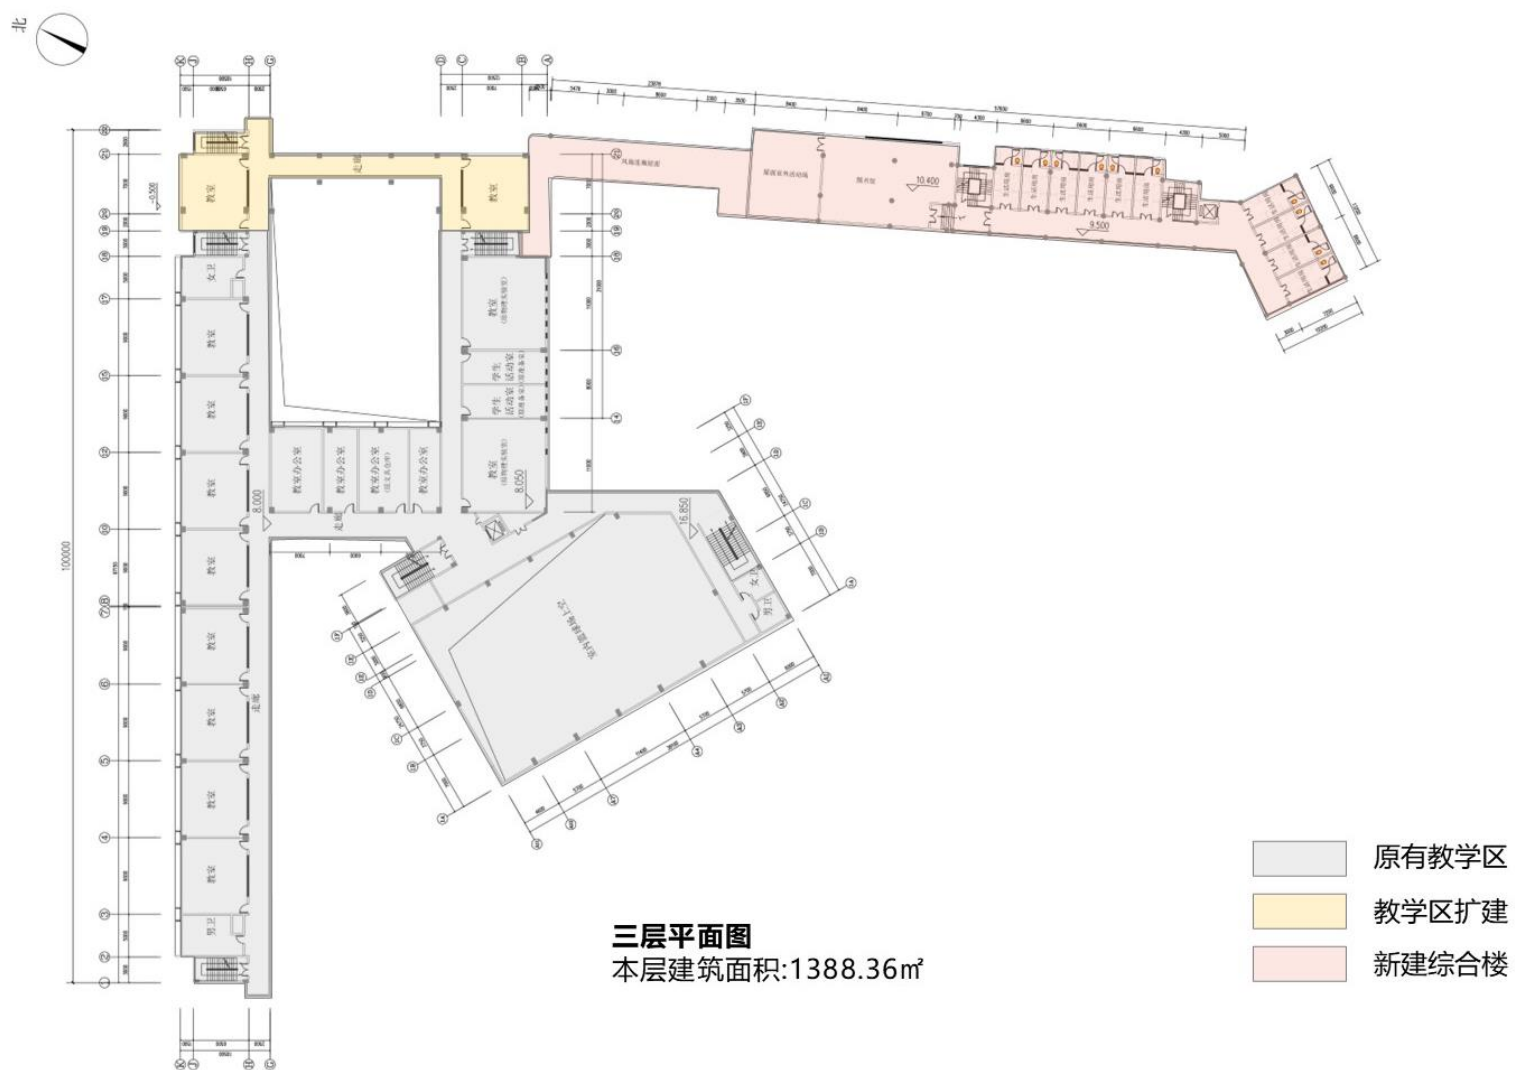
新建综合楼及电梯工程三层改造平面图
